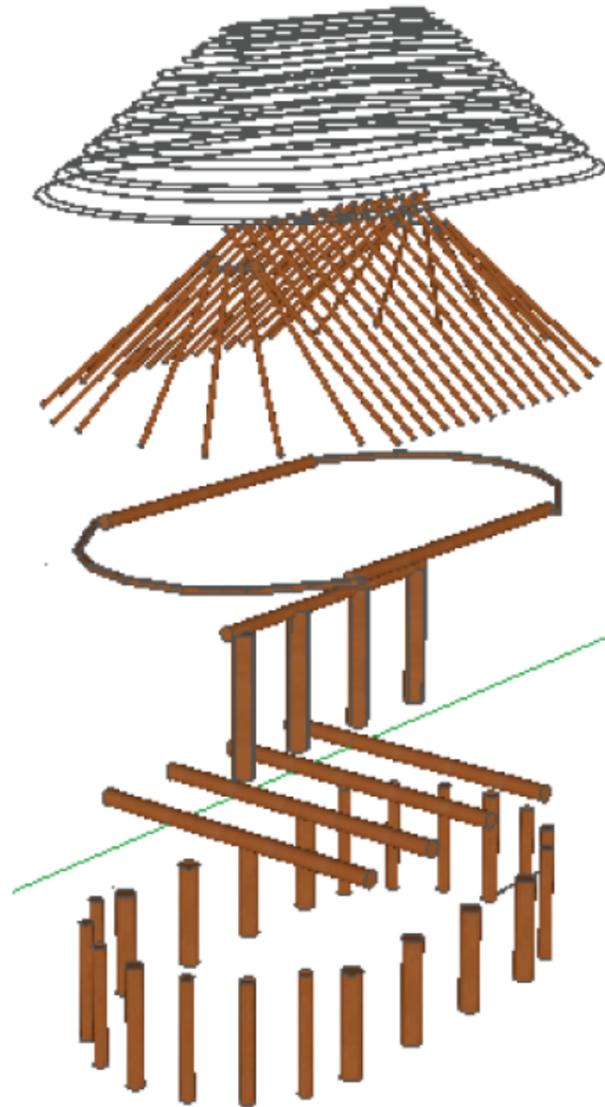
Axonometría del sistema constructivo. Tomada de (Chimbo, Sofia, 2013.)
